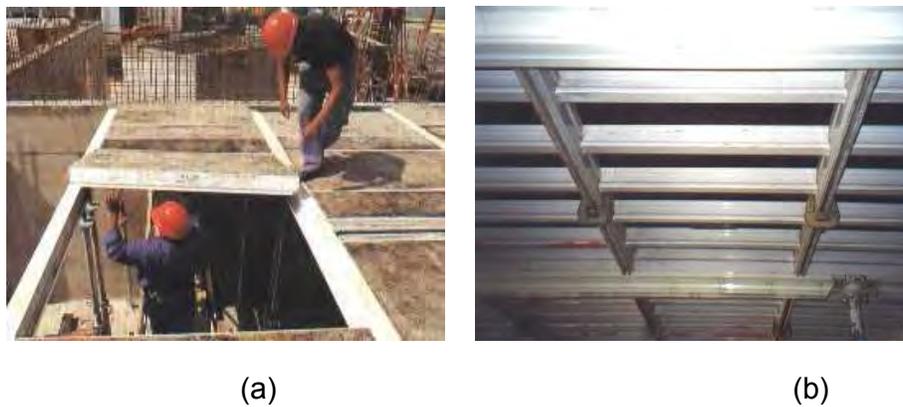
Sistema modular para lajes: a) montagem dos painéis apoiando-os em vigas metálicas; b) vista inferior do sistema montado – FREIRE (2001).
